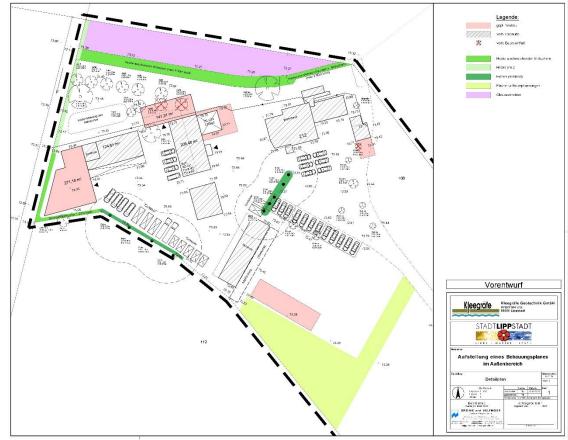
Lage der Kompensationsmaßnahmen und der zu erhaltenden Bestandeile im Plangebiet (vollständige Abbildung siehe Anhang).
